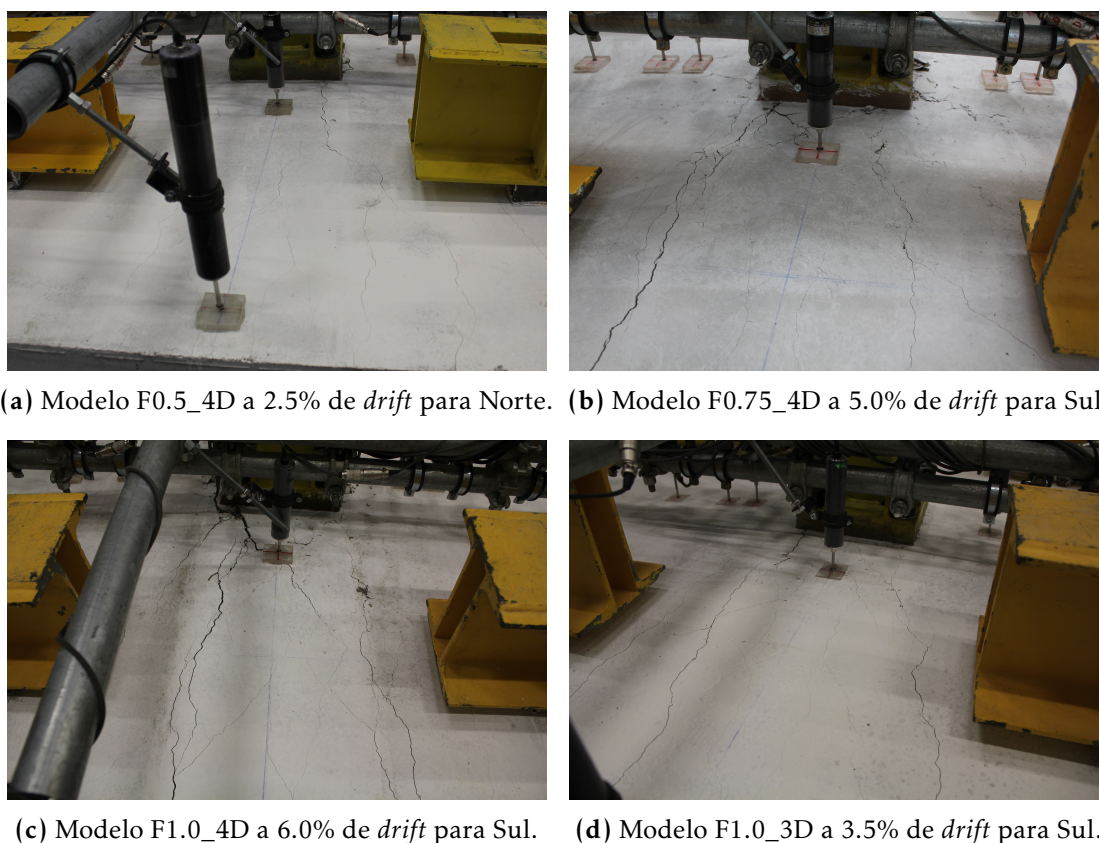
Fotos da face superior dos modelos de laje para *drifts* elevados.
